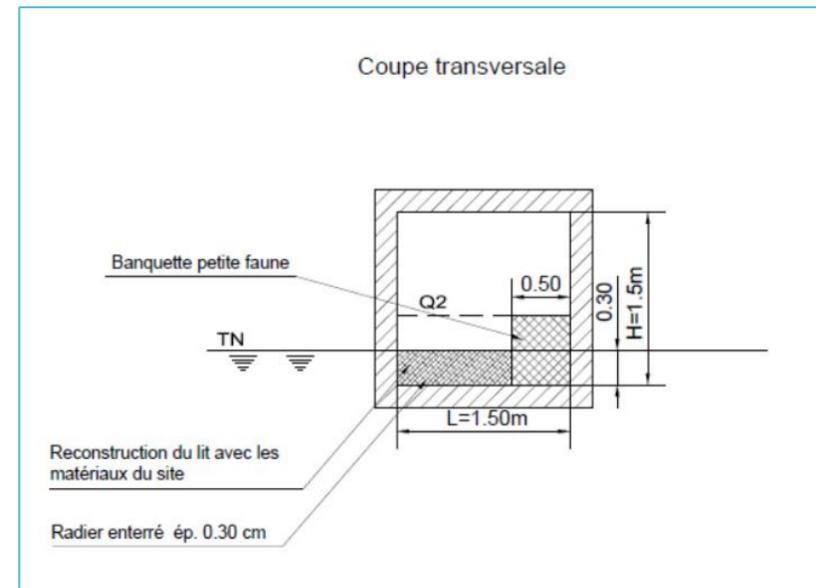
Coupe ouvrage mixte hydraulique (source : Setec 2023)
